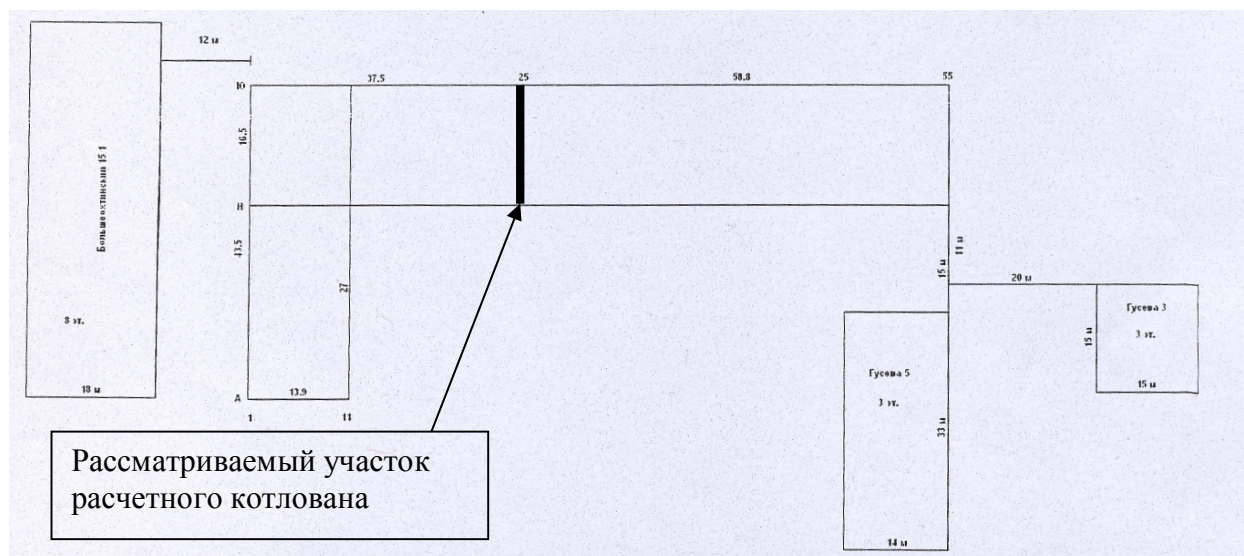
Размеры здания С-1 в плане, расположение примыкающих зданий
